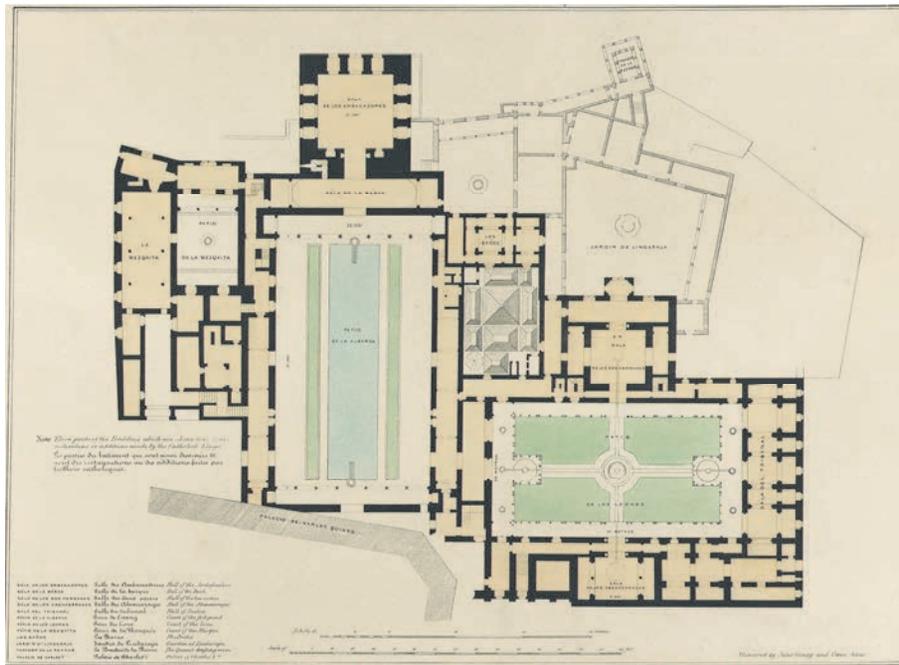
O. Jones y J. Goury. Planta de la Casa Real Vieja de la Alhambra, en *Plans, Elevations and Sections of the Alhambra*, 1842-45.
